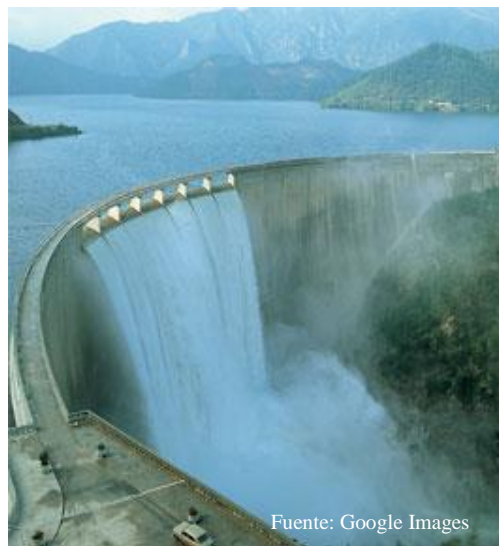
Vertedero de compuertas en presa concreto tipo bóveda.
